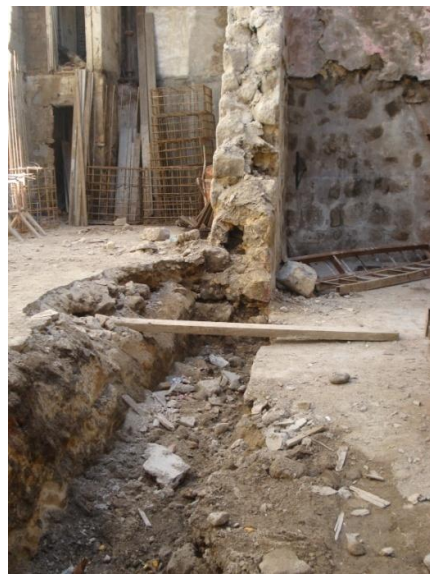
Parede de alvenaria após colapso (Sara Ferreira, 2013)
